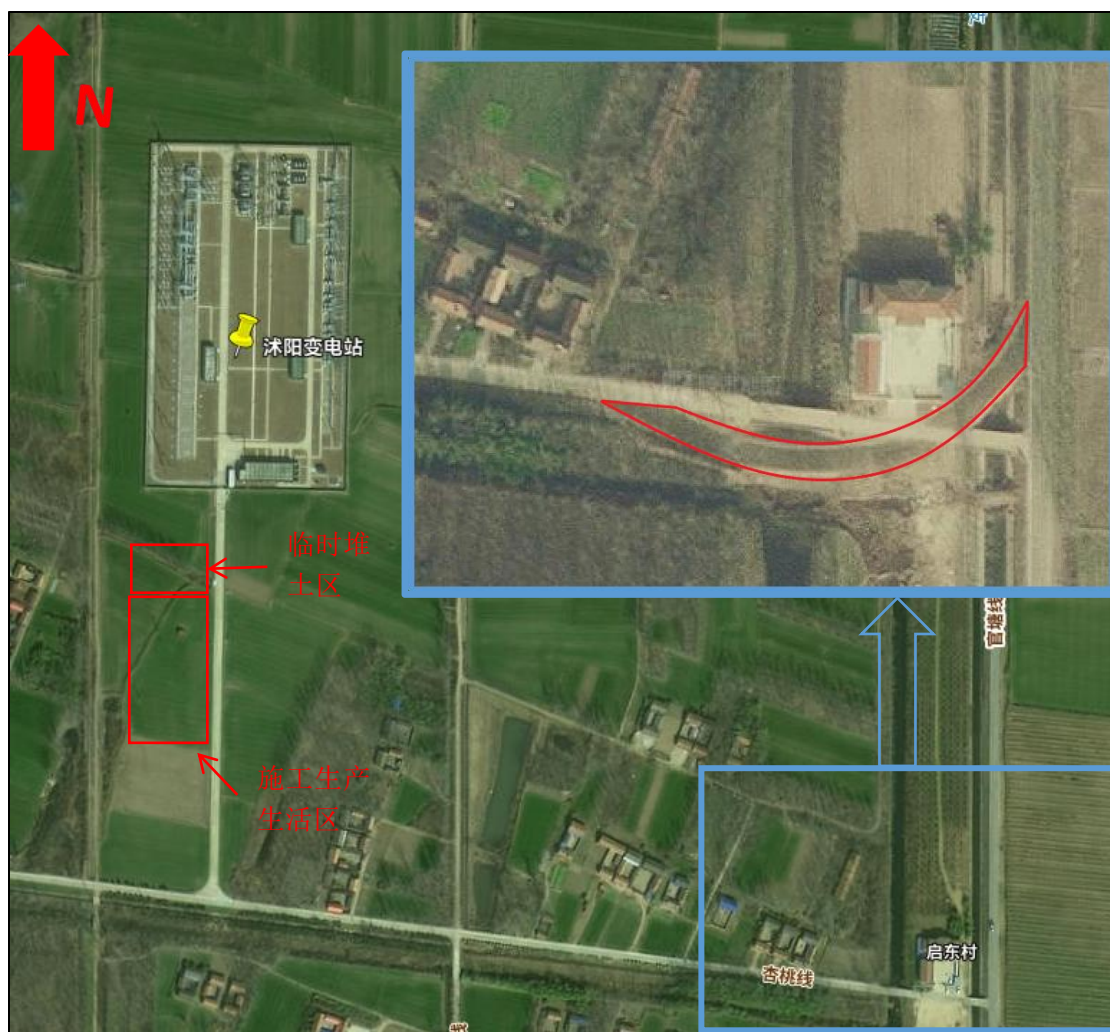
施工临时道路区、施工生产生活区、临时堆土布设位置
